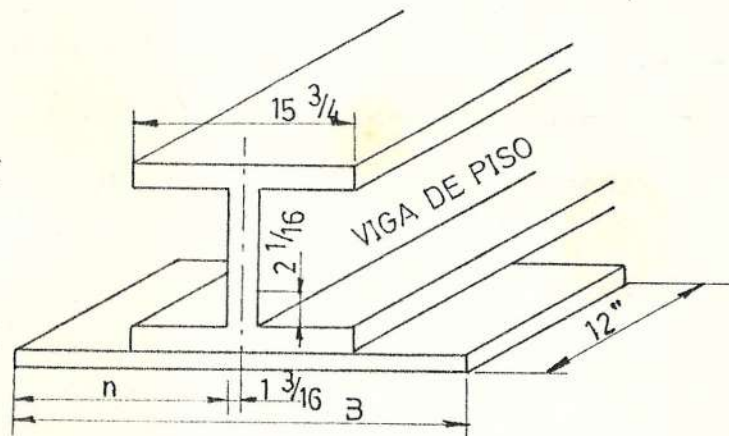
DISEÑO DE LA PLACA SOPORTE SUPERIOR.
